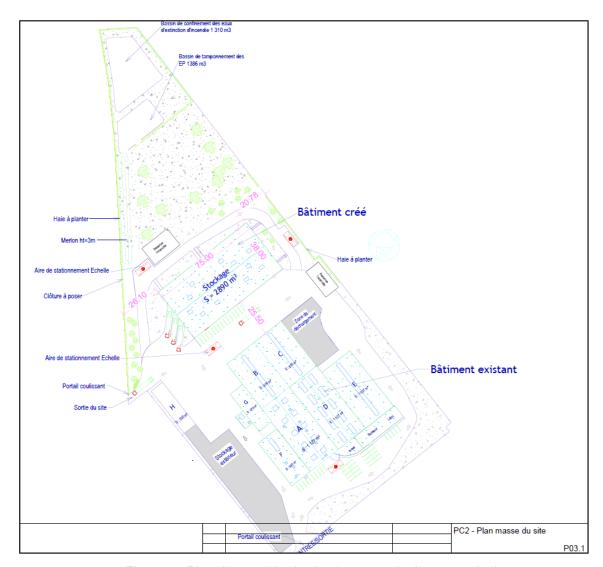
Plan d'ensemble du site (source : sicabconstruction)
